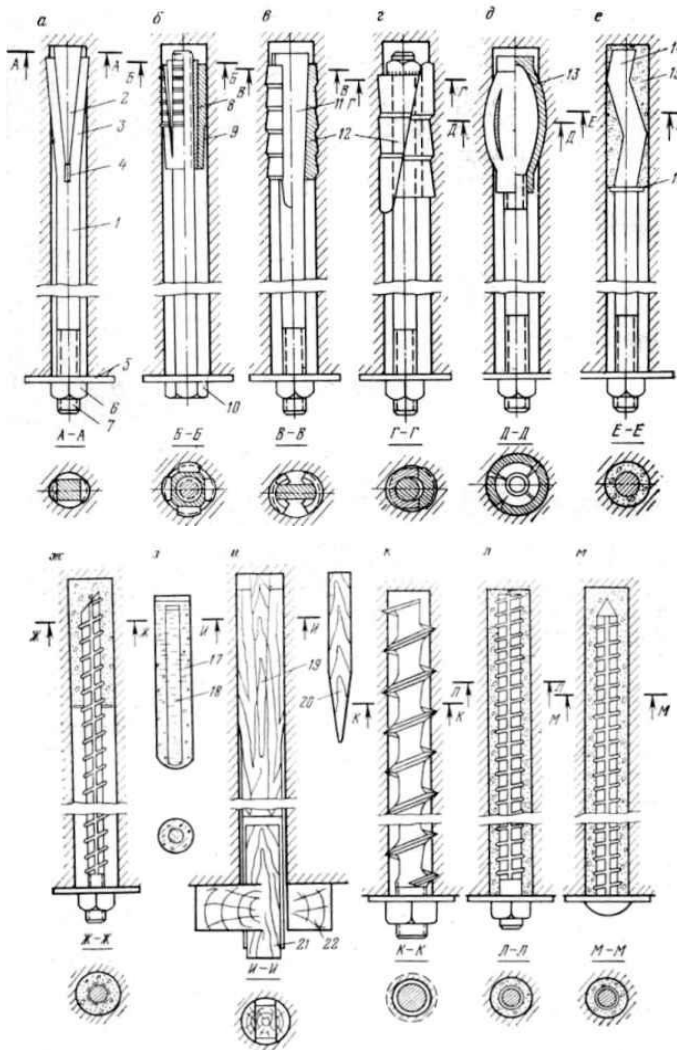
Різновиди анкерів: а – клино-щілинний, б – г – розпірний, д – вибухо-розпірний, е, ж – залізобетонний із замковим закріпленням, з – ампула, и – дерев'яний анкер, к – гвинтовий анкер, л, м – залізобетонні анкери із повним закріпленням; 1 – штанга, 2, 20 – клин, 3 – вуса, 4, 19 – щілина, 5 – опорна плитка, 6 – гайка, 7 – клинова голівка, 8 – стакан, 9, 12 – гільза, 10 – болт, 11 – розплющений кінець, 13 – трубчата голівка після вибуху, 14 – хвилеподібний стержень, 15 – бетонний або полімерний заповнювач, 16 – обмежувач, 17 – активний состав, 18 – отверджувач
